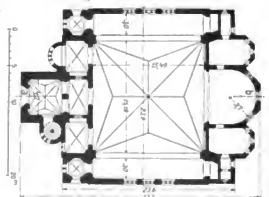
Aufsicht auf die Dachkonstruktion unter Weglassung der Dachhaut (Bänder und Sparren in Eisenbeton.)
